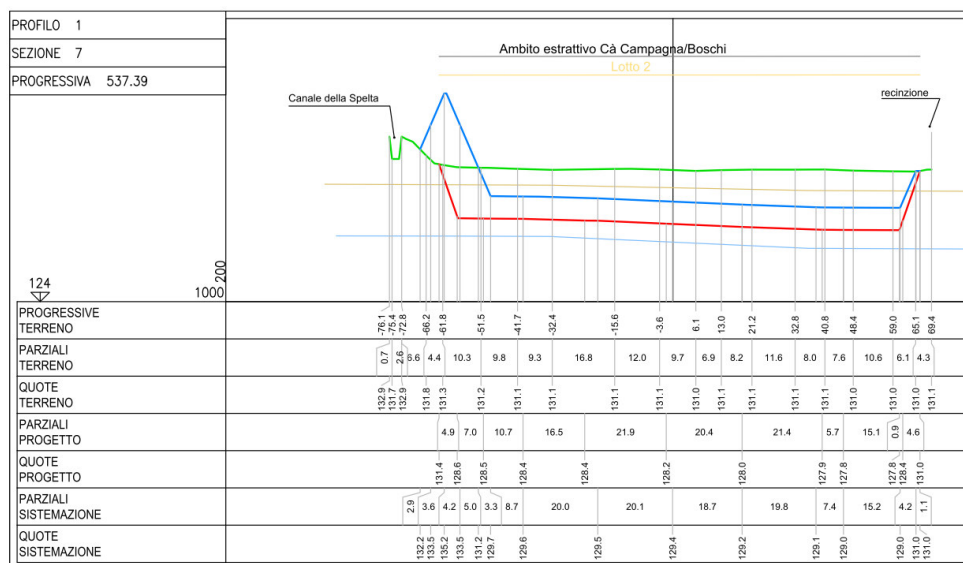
Estratto tav. P02 'Sezioni' del Piano di coltivazione (deformata verticalmente)
